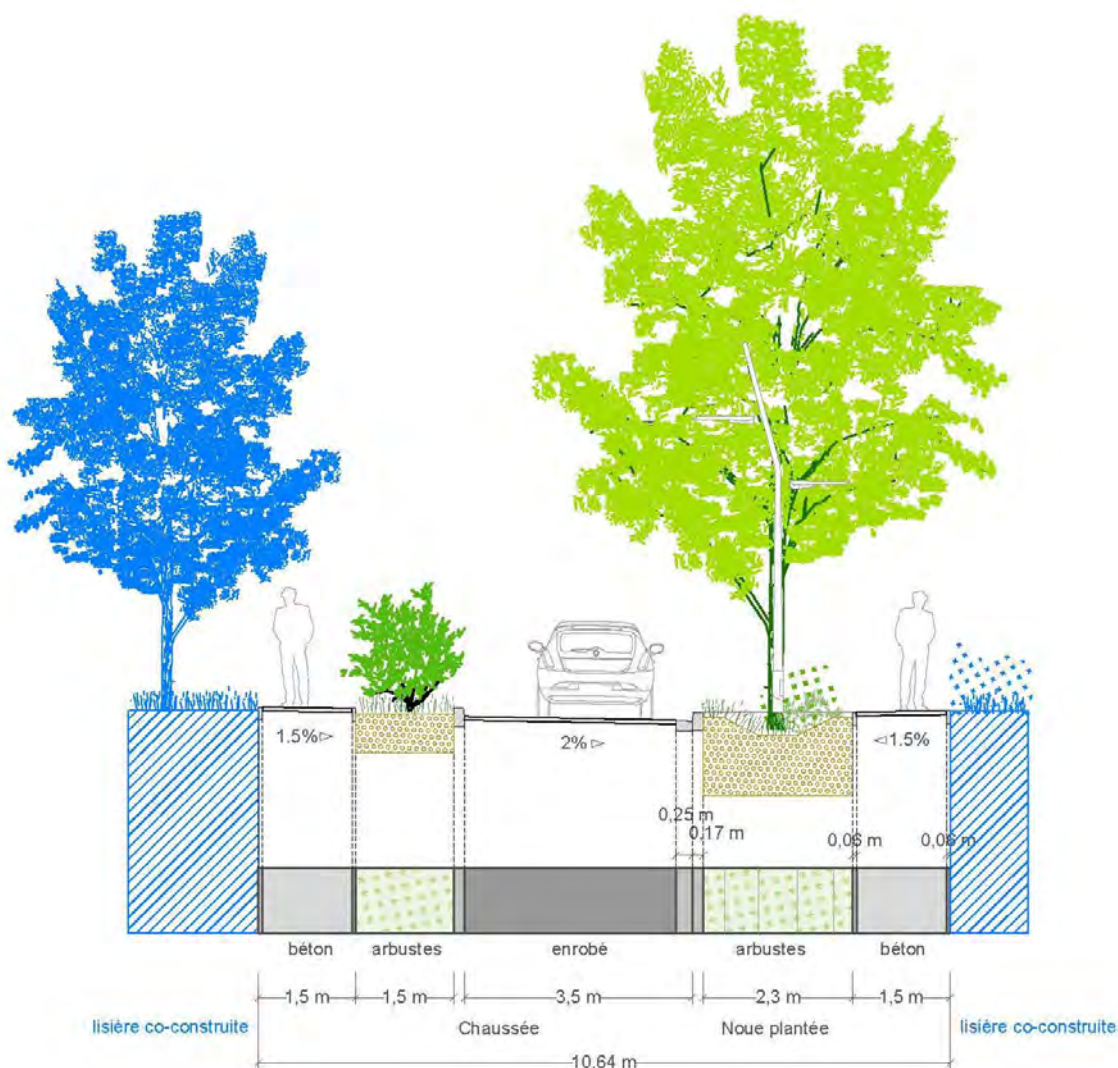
Profil-type de l'équipement public secondaire Voie Pointe Sud (f) (coupe 13 - 10.64 m)
